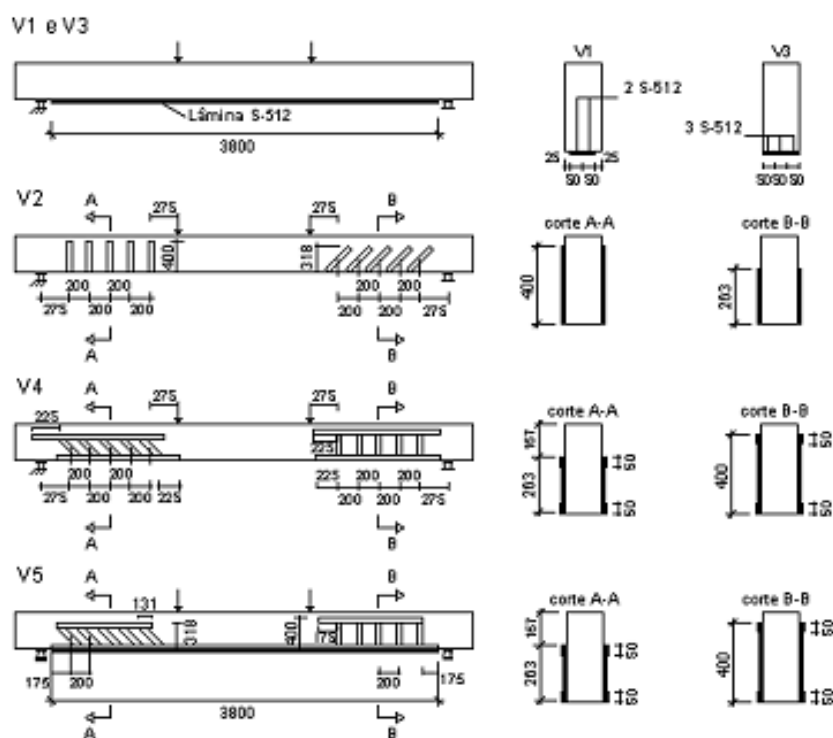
Vigas ensaiadas por Pinto e Cerqueira (2000)
